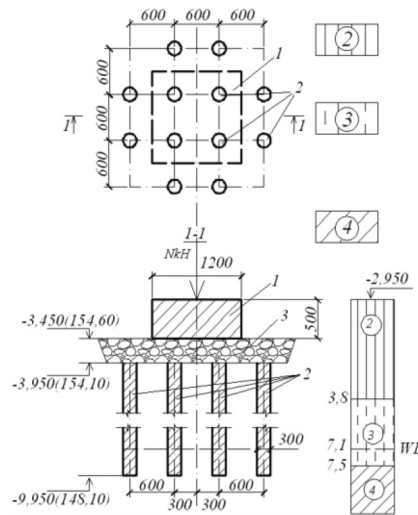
Схема випробувань основи, яка армована вертикальними ґрунтоцементними елементами, залізобетонним квадратним штампом:
